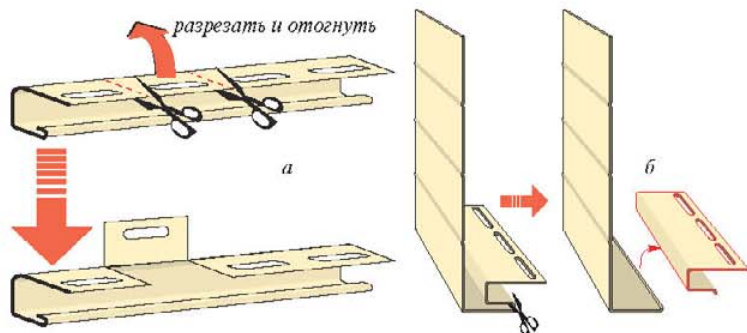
Подготовка профилей: а — изготовление F-профиля из J-профиля; б — обрезка J-фаски
